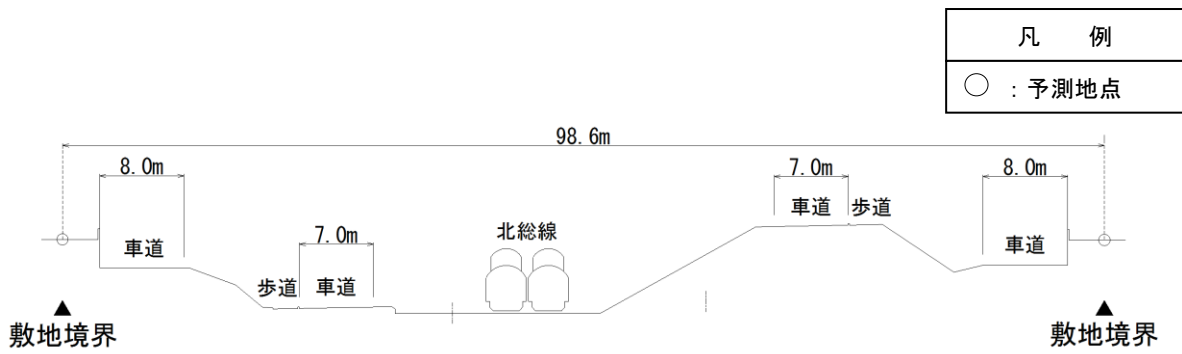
(8) 予測断面図 (H. 一般国道464号 (5))
